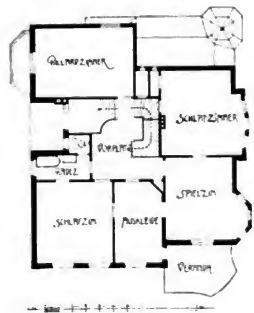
542. Wohnhaus Voigt, Osterdeich. Fassade u. Grundrisse. Wellermann & Frölich. 1899.
